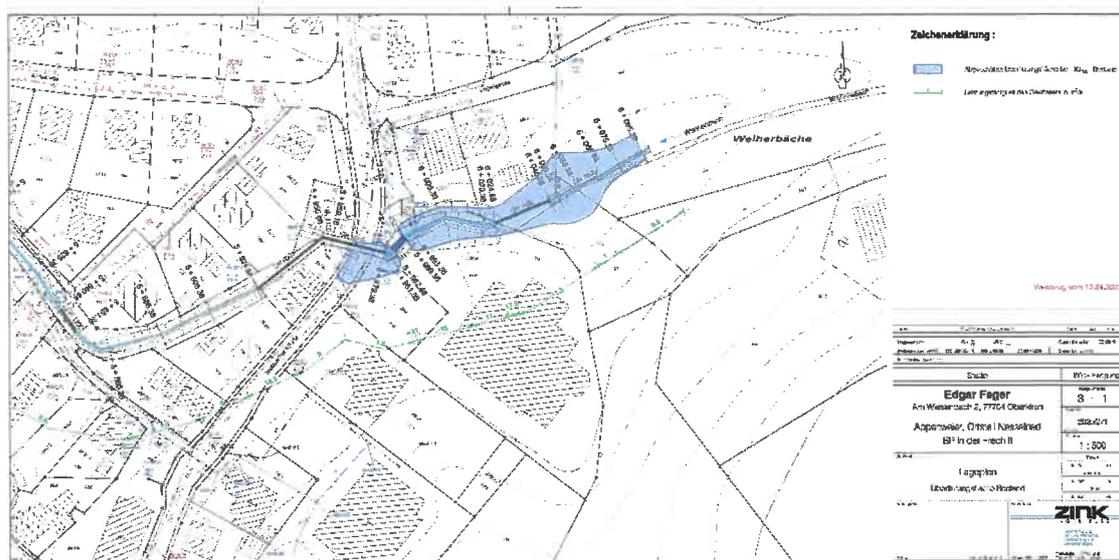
Lageplan Überflutungsfläche Bestand; Zink Ingenieure. 09.07.2021
